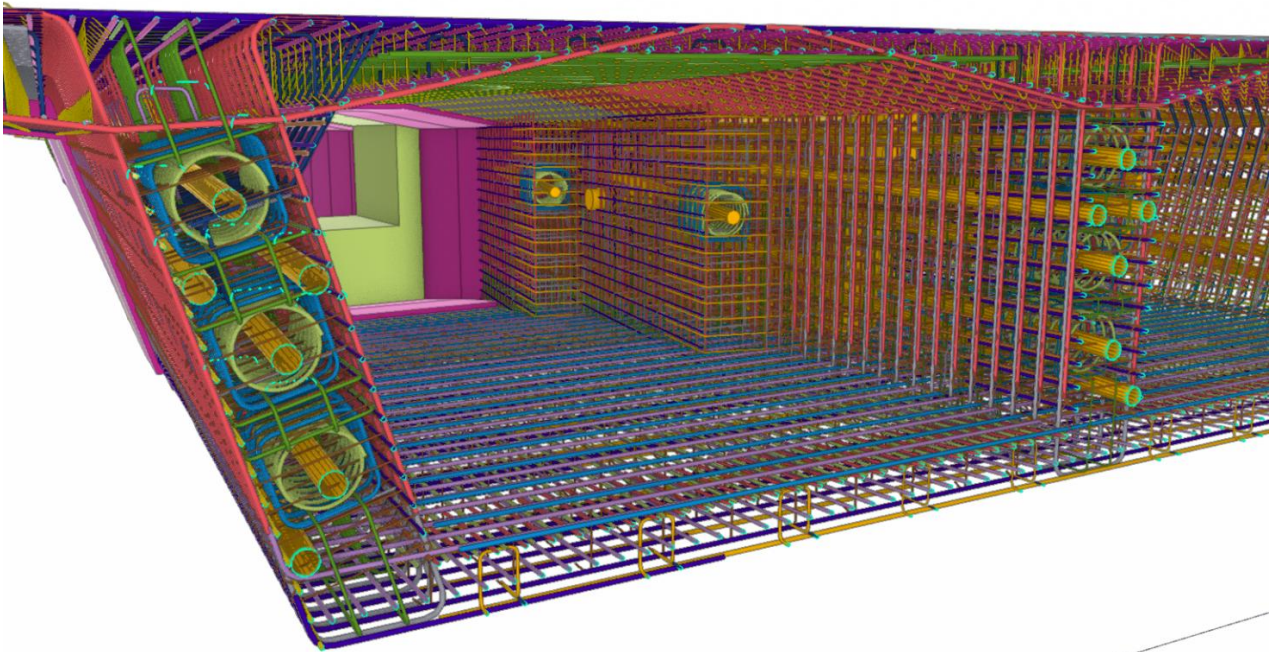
Modelo 3D con armaduras de refuerzo y pretensado en Tekla Structures
